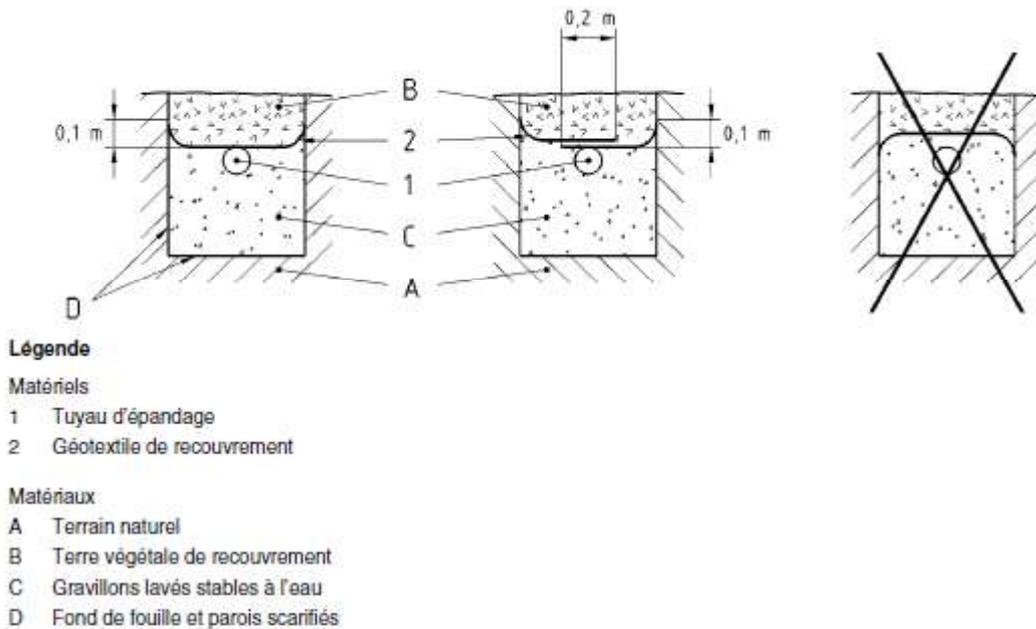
Coupe : Mise en œuvre du géotextile de recouvrement
